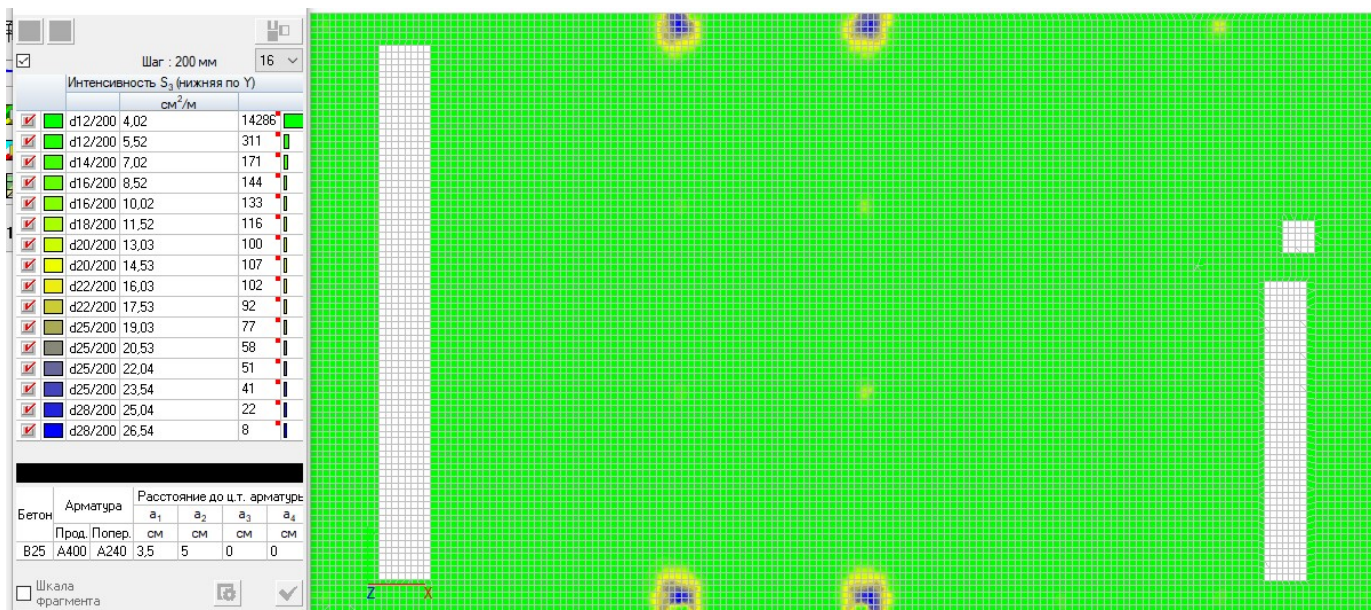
Нижнее армирование по Y (шаг 200 мм)
